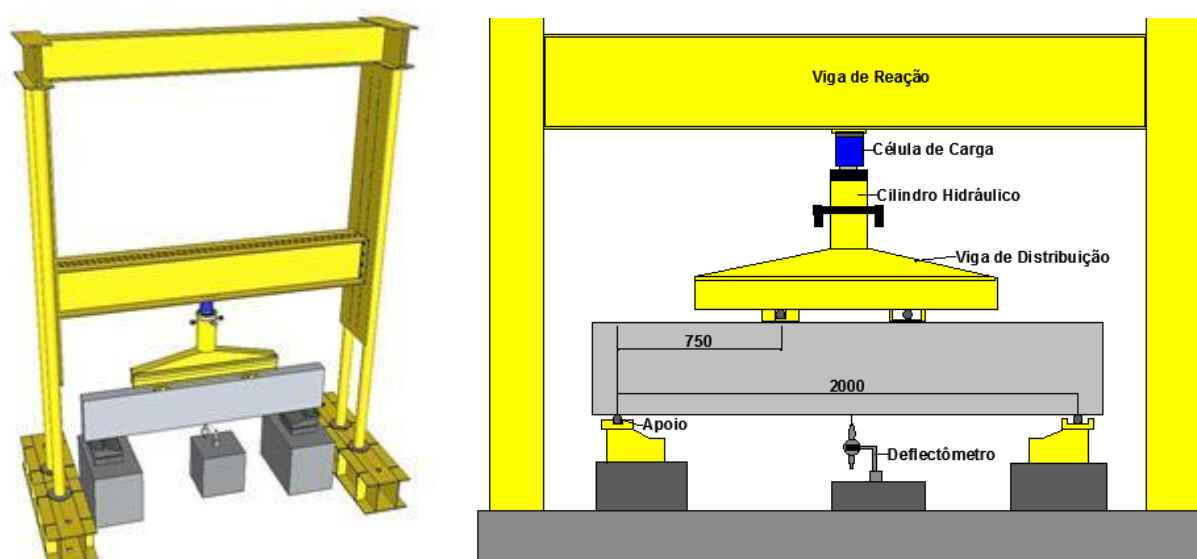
Vista 3D e esquema do modelo de ensaio de Stuttgart
